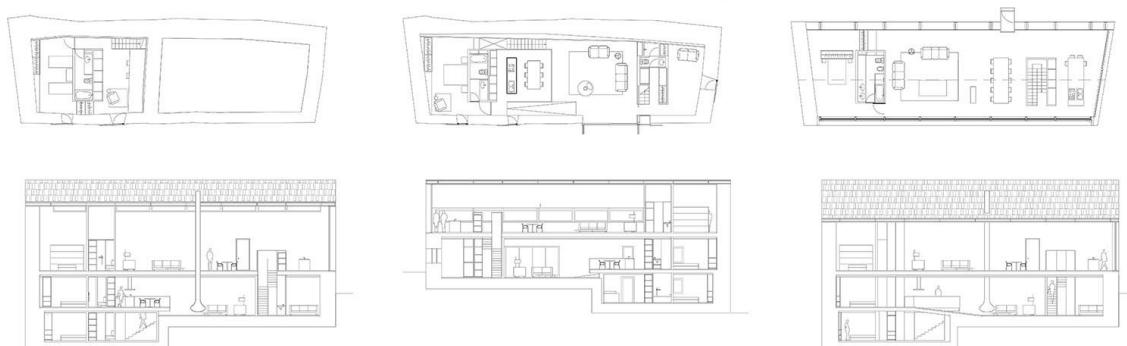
Plantas y secciones [Cadaval & Solà Morales]
